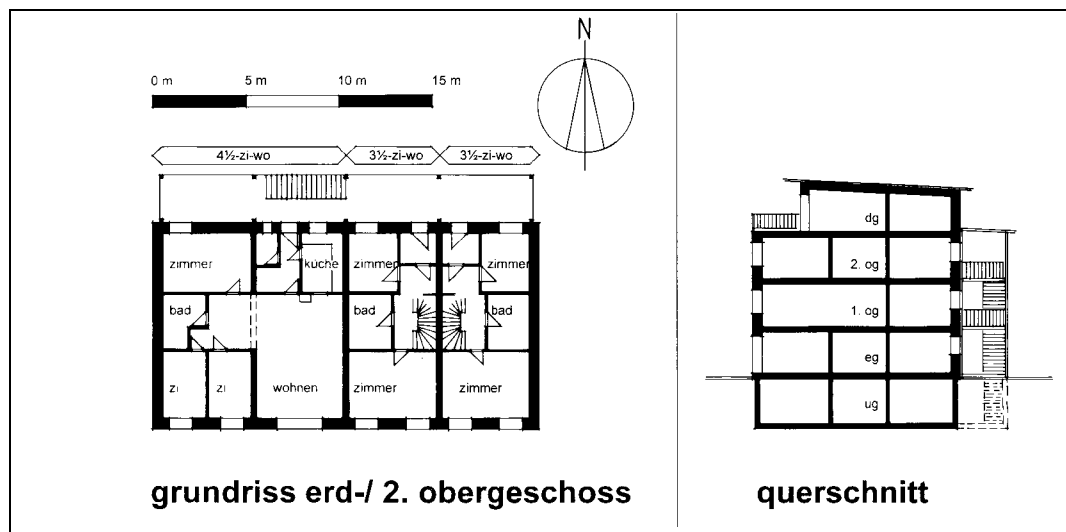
Grundriss Erd-/ 2. Obergeschoß und Querschnitt von Objekt N_mfh.
